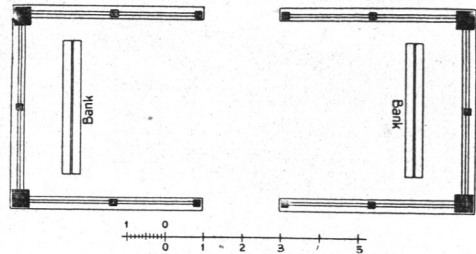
Rixbütteler Schlossgarten in Cuxhaven, Schutzhalle, Grundriß.
